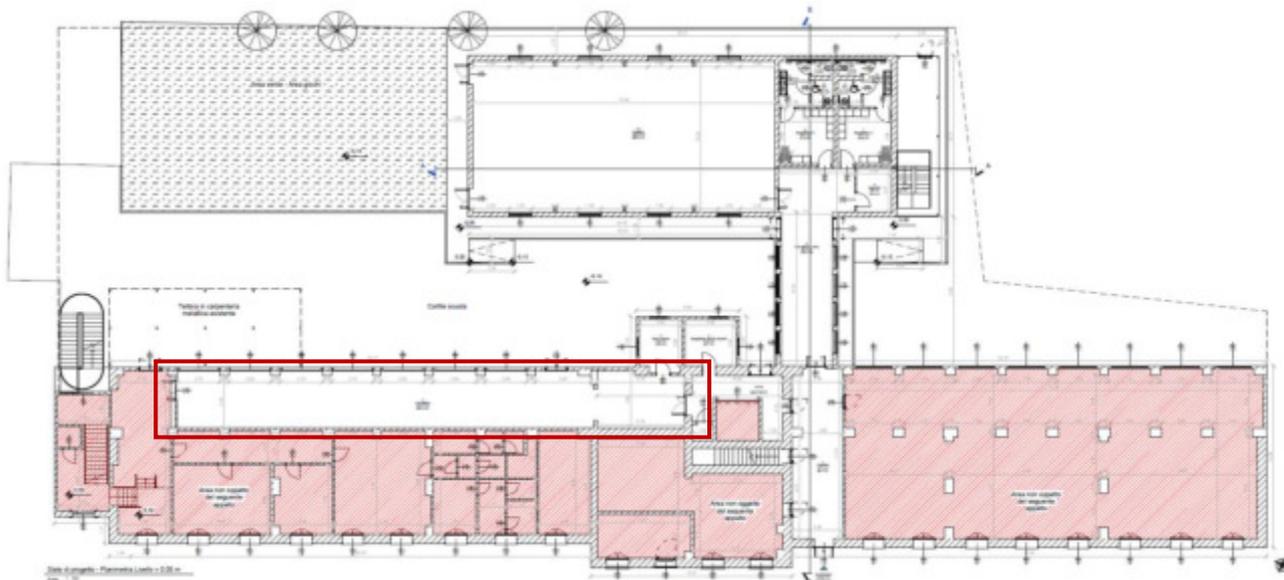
Stato di progetto – Planimetria Livello +0,00m
